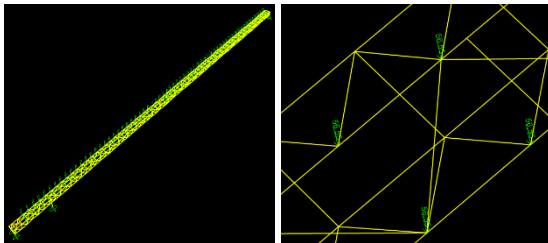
Aplicación de la Sobre Carga Muerta debido a la pasarela de acceso, HGU2.421-BT5. Fuente: SAP2000v18.
